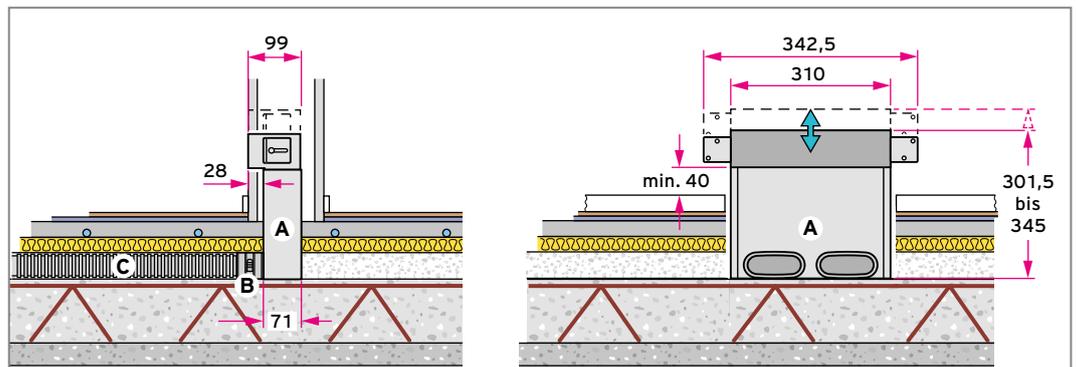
Rechteckiger Luftauslass, Wandmontage - Verlegung im Fußbodenaufbau
